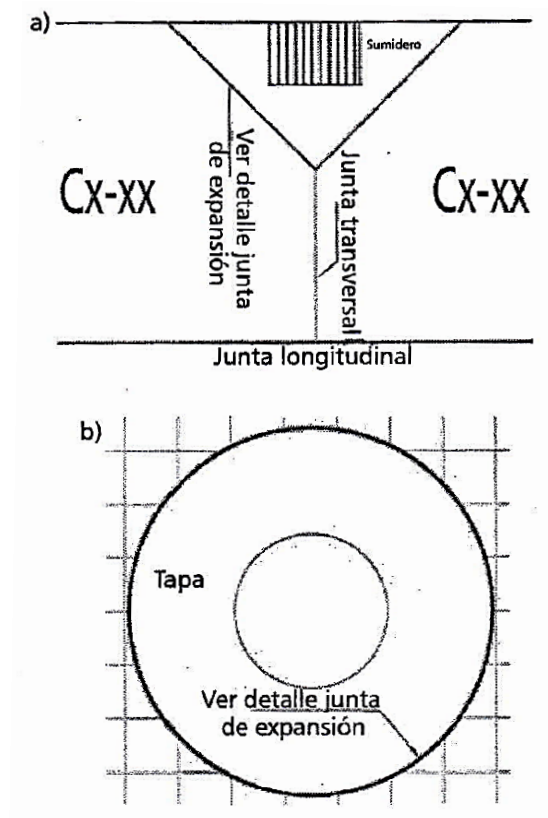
Ejemplo de una vista en planta de juntas de expansión:
